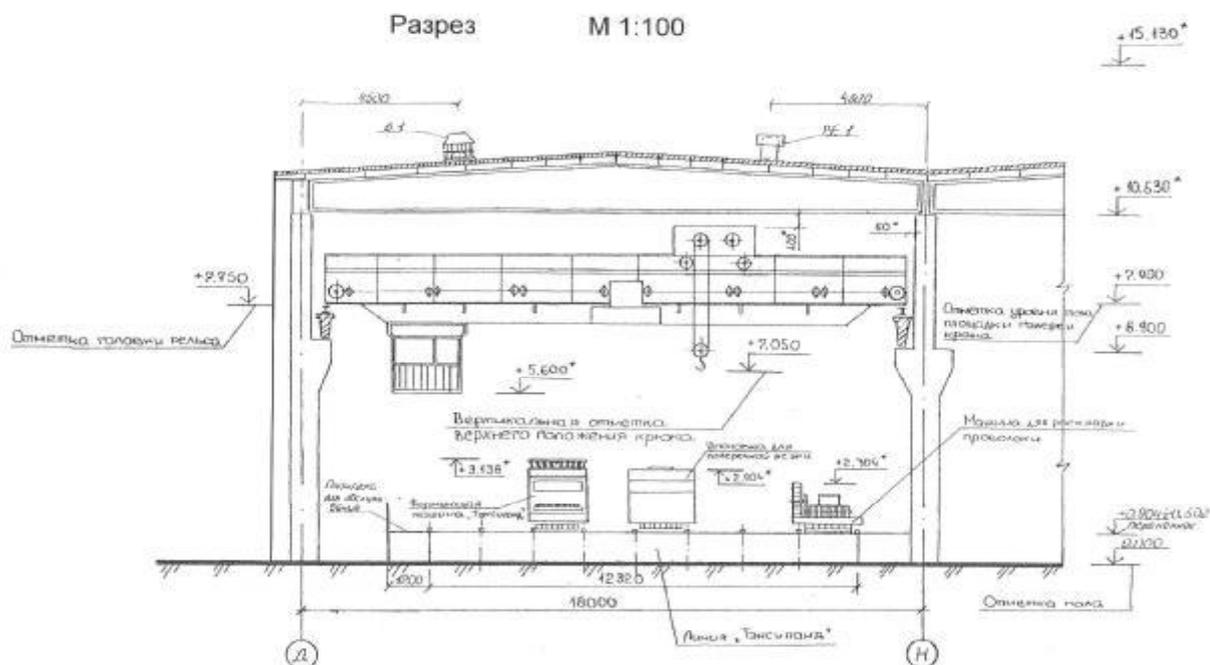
Поперечный разрез формовочного цеха по производству многупустотных плит перекрытия экструзионным способом
